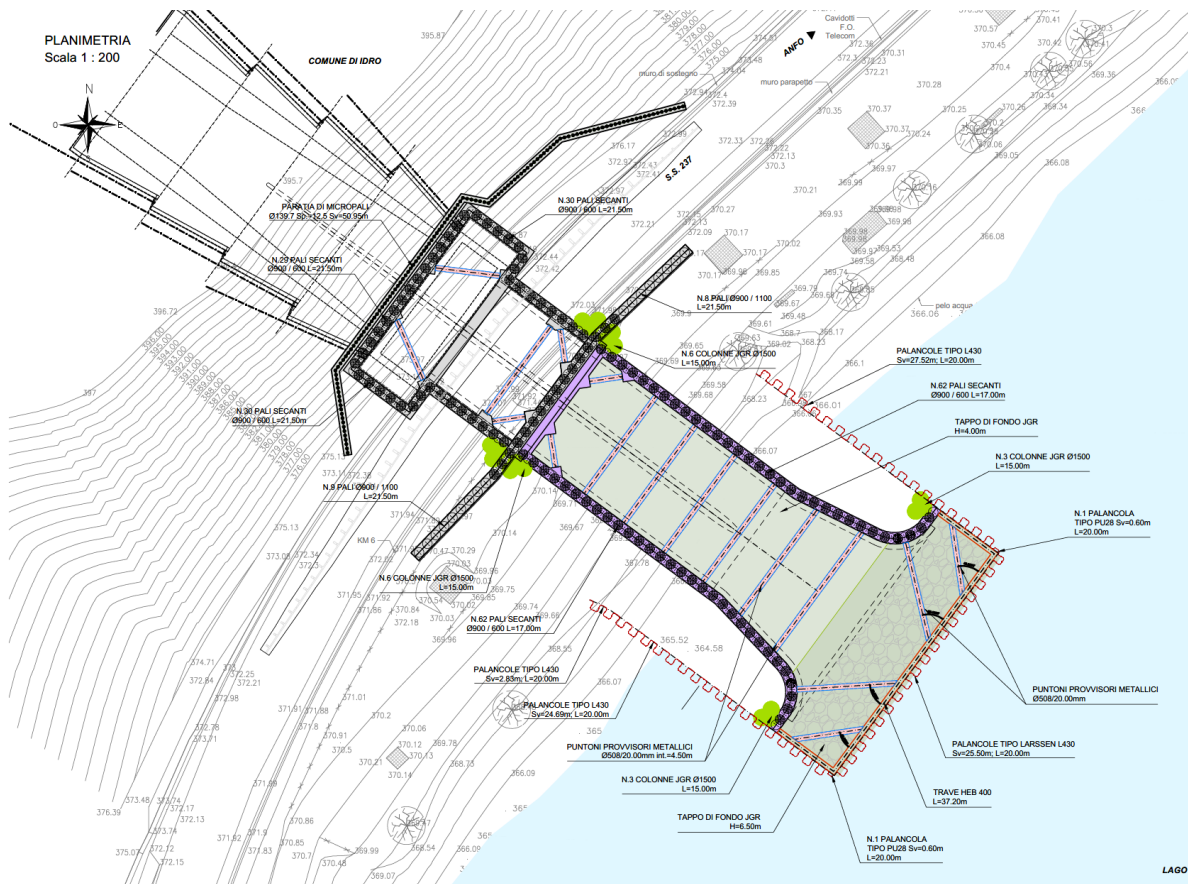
Imbocco - Opere provvisorie - Planimetria di progetto
